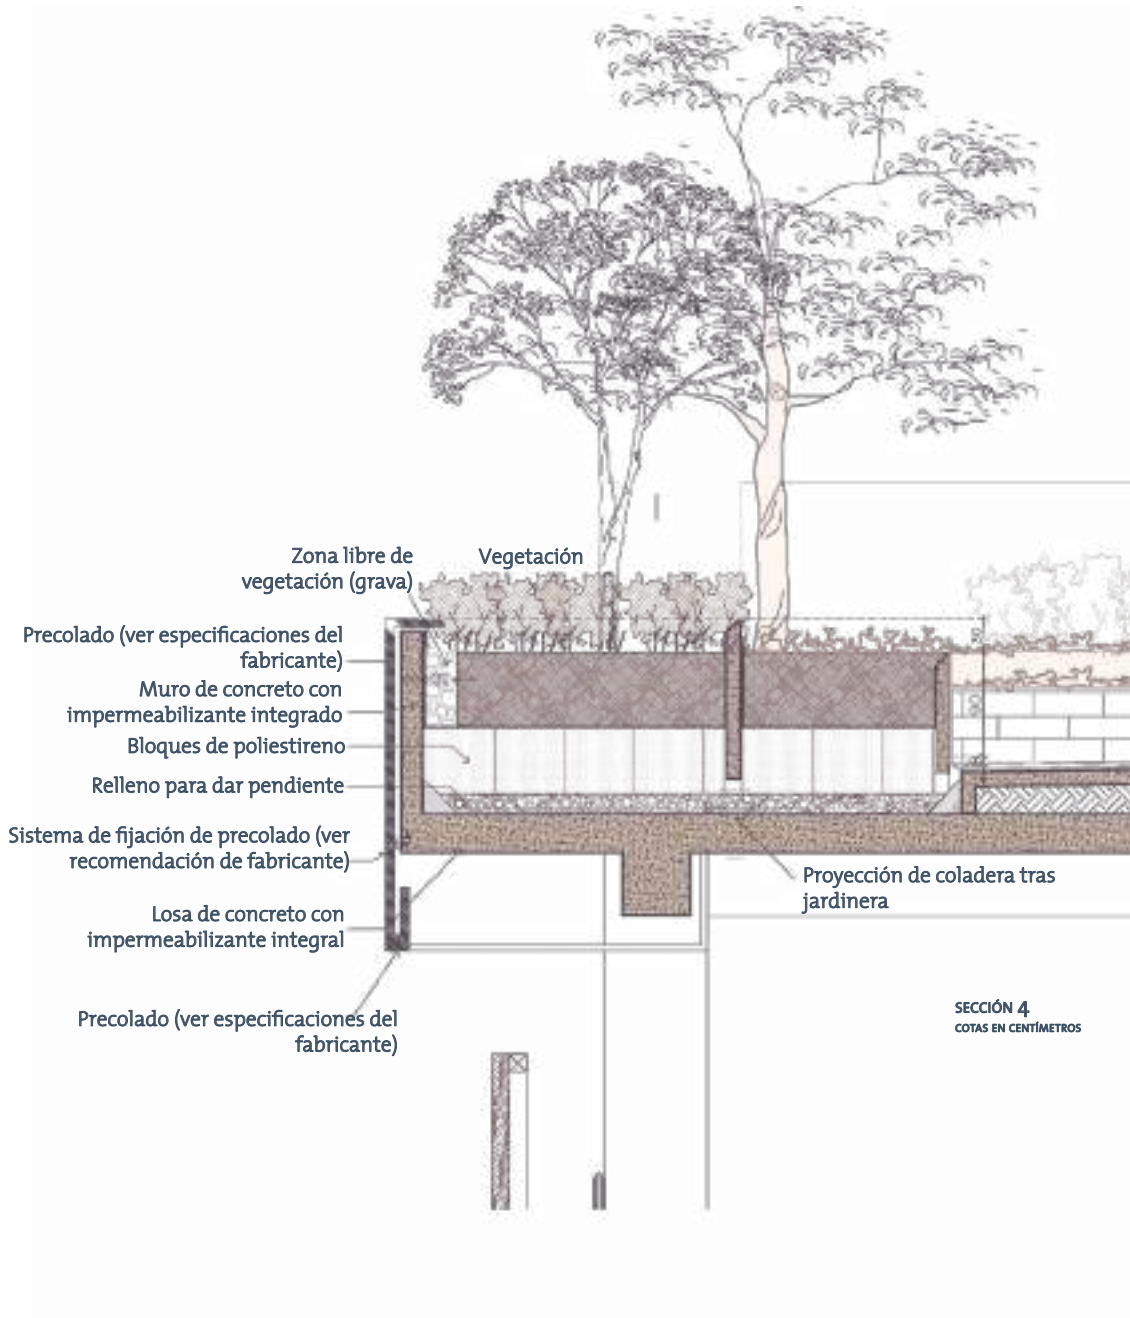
Detalles de jardineras sobre estructura, conjunto Miyana, Polanco, Ciudad de México
